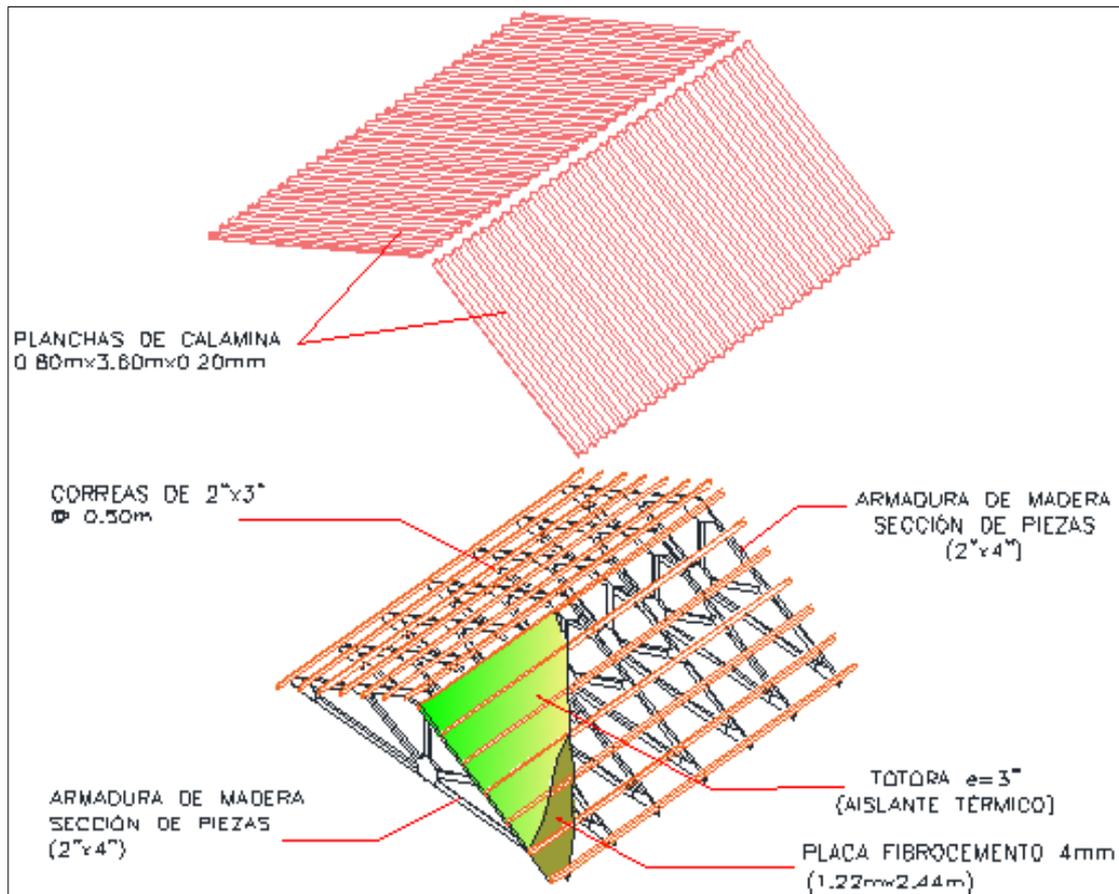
Cobertura de techo del sistema constructivo propuesto
